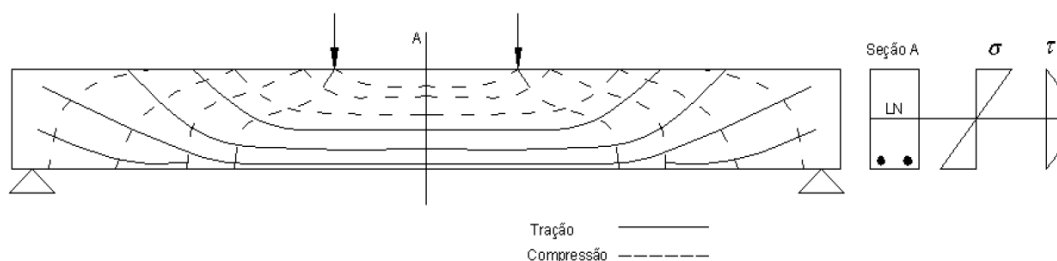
Planos de tensões principais em vigas não fissuradas.
